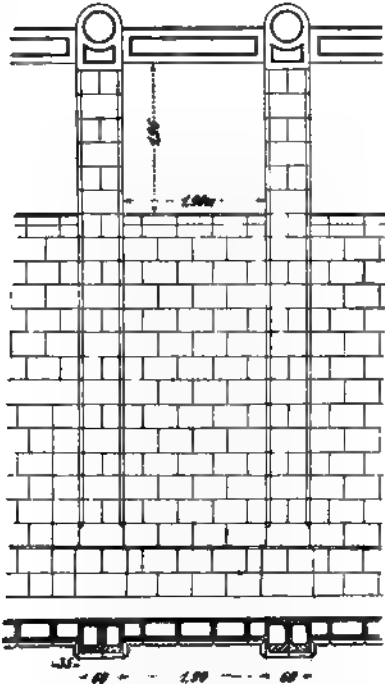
u. 47. Ansicht und Grundriß der Vorderfront eines in Aerolith-Steinen ausgeführten Gebäudes.
